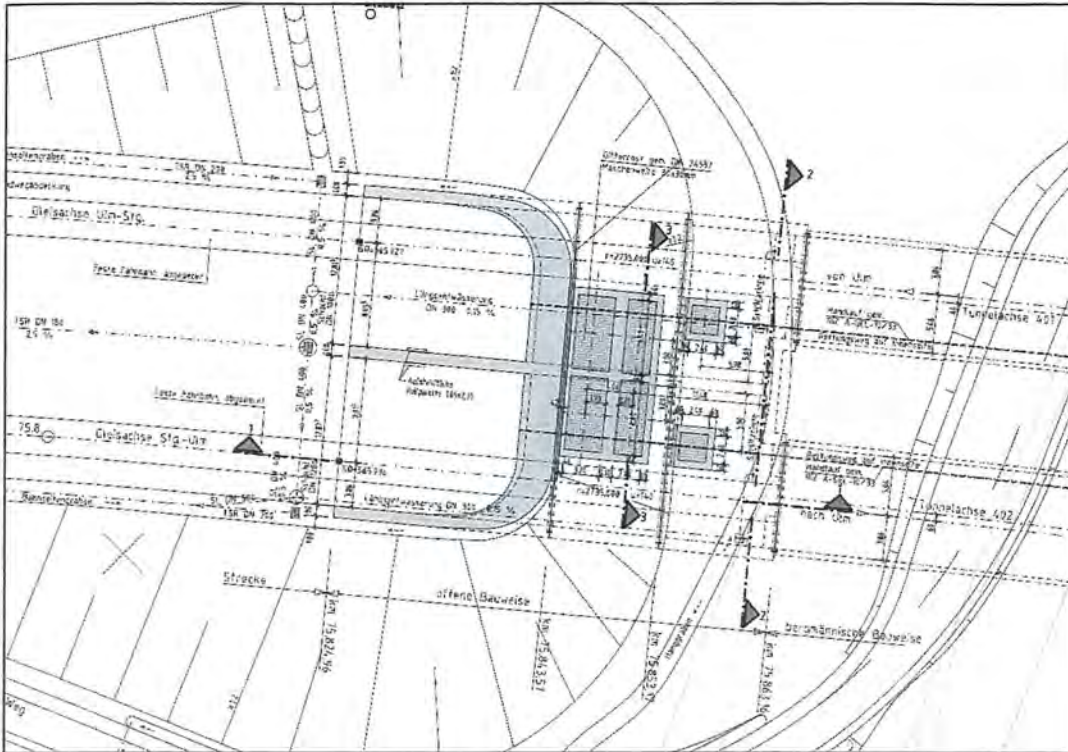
Lageplan (Ausschnitt) Portal Dornstadt [MH13b]
